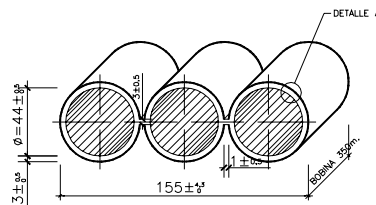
Tritubo para automatización y control de redes de alcantarillado
